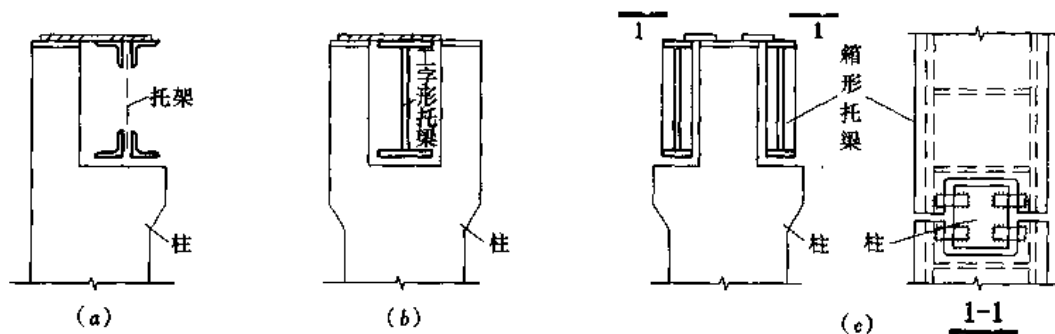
托架、托梁与钢筋混凝土柱的抗扭连接
